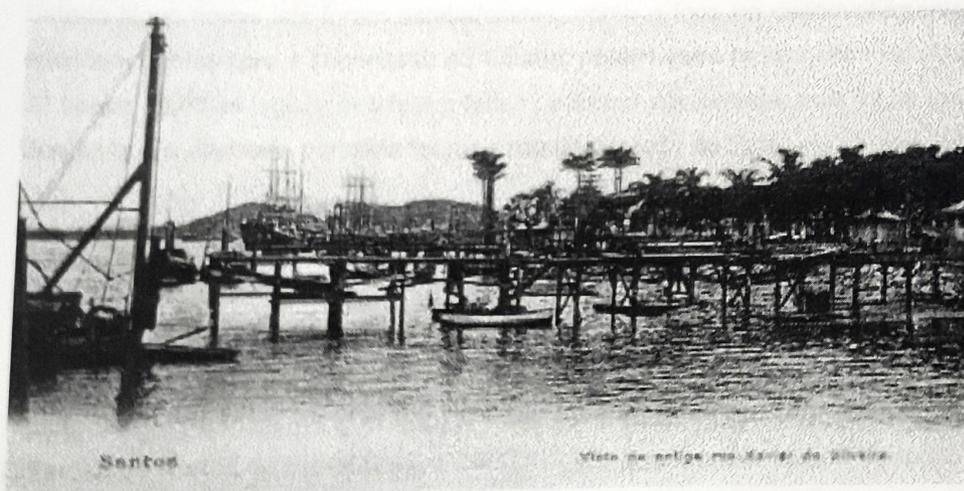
Antigas instalações do porto de Santos – Trapiches.
